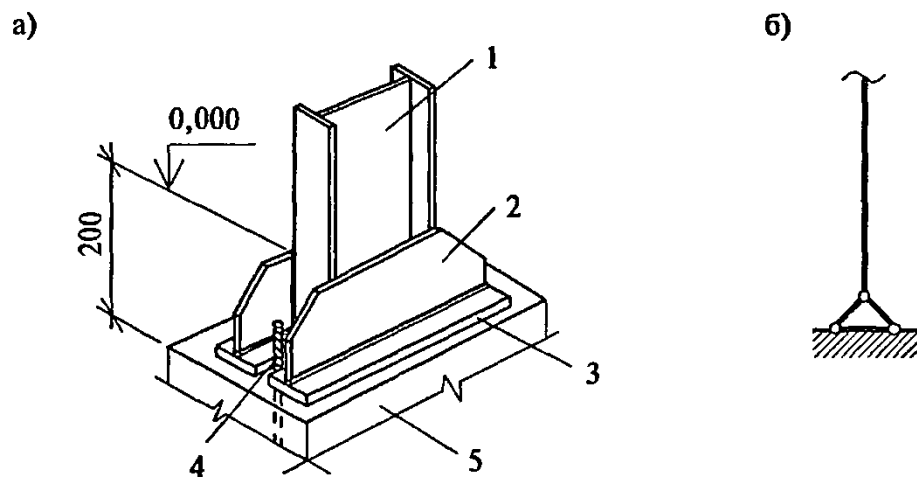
Шарнирное крепление колонны к фундаменту:
